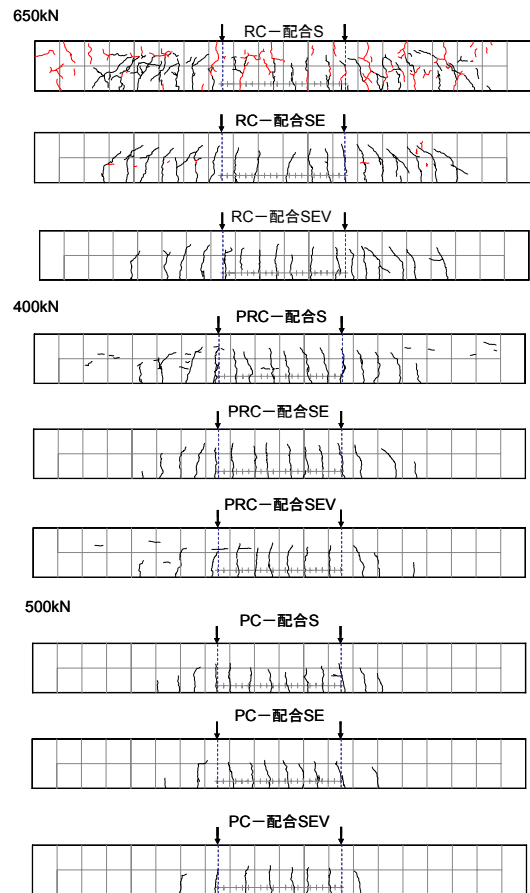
主鉄筋降伏前のひび割れ状況 (RC の収縮ひび割れ：赤、PRC・PC の割裂ひび割れはスケッチせず)
